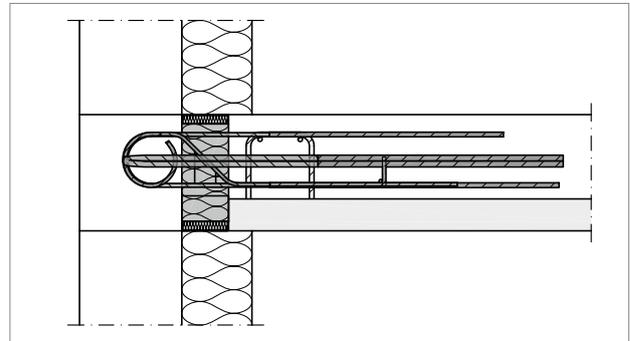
Schöck Rutherma® T type DF-S : liaison pour façade en béton armé et plancher constitué de prédalles
